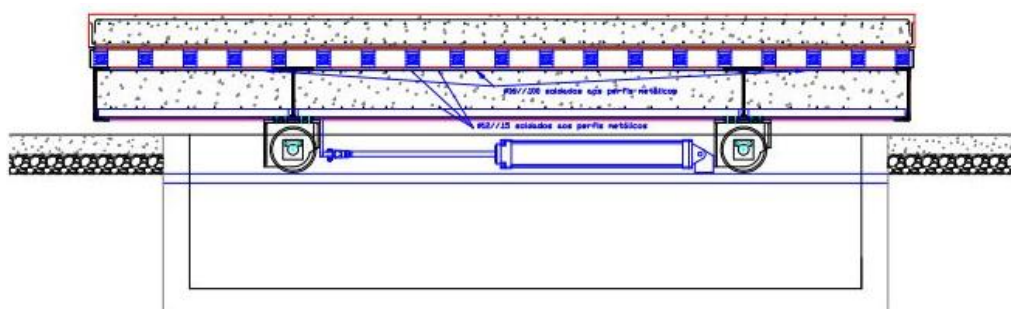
Sistema de movimentação da câmara horizontal (Tadeu et al. 2008)
